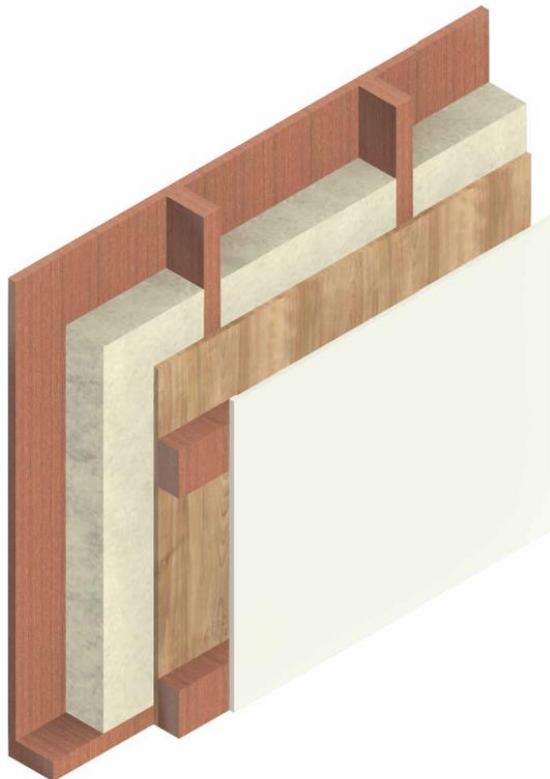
Ejemplo sistema constructivo con base a marco de madera
